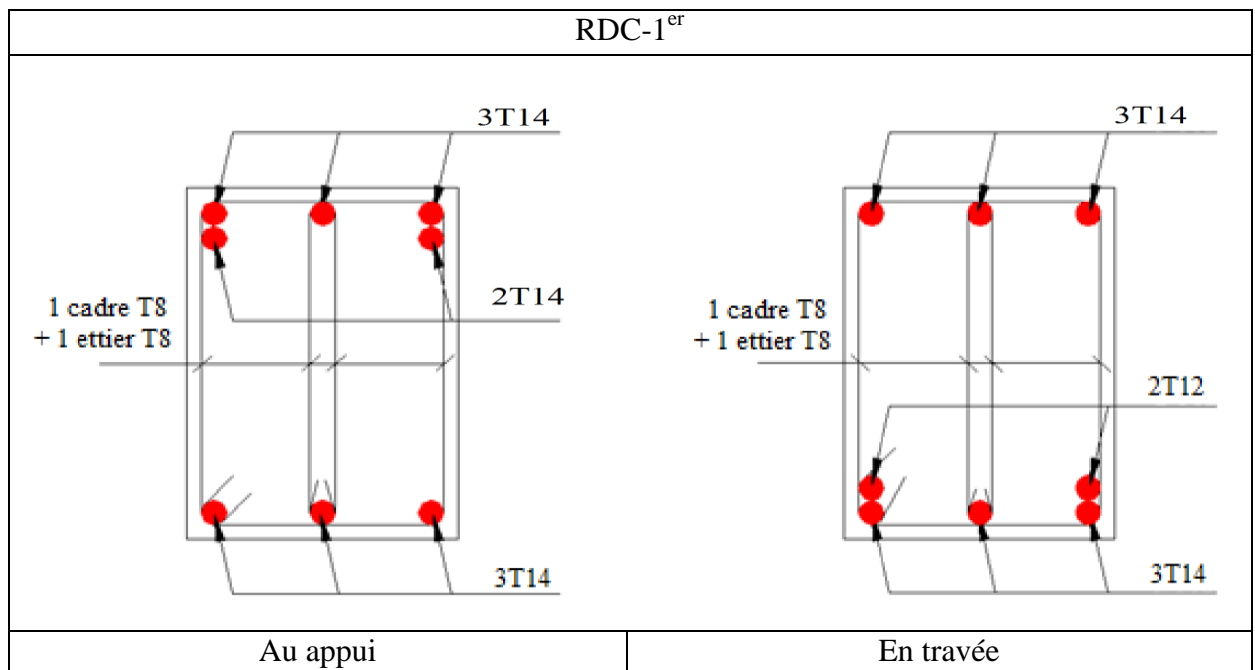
Ferraillage des Poutres porteuses de RDC ET 1^{IER} étage
